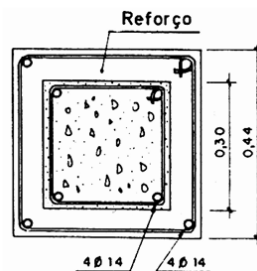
Seção de um pilar reforçado por encamisamento de betão armado (12).
